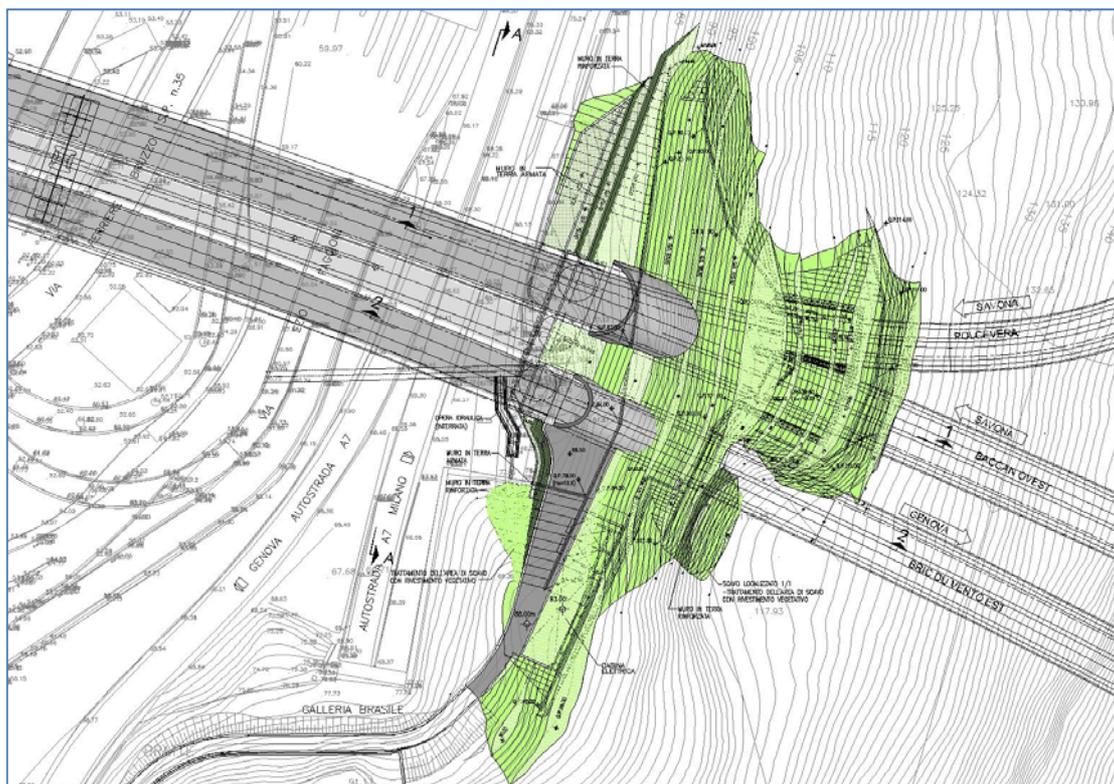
Stralcio planimetrico del rimodellamento morfologico (cfr. AUA0166-2)
